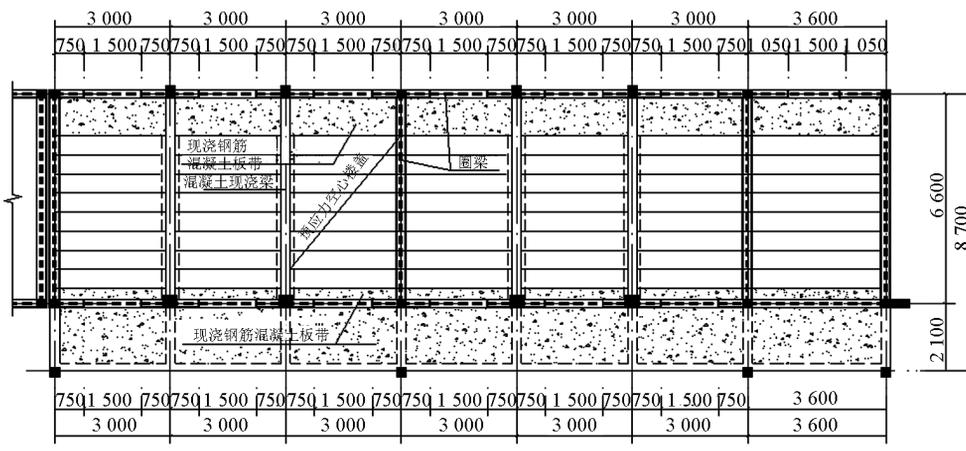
教学楼屋层面圈梁及现浇板带布置图 (单位:mm)
